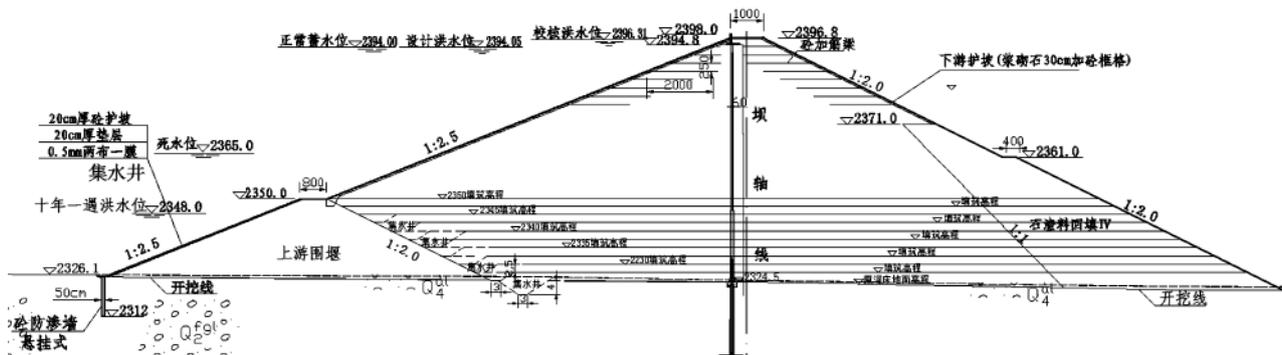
方案二：围堰基础悬挂式防渗墙设计及施工布置横断面图
